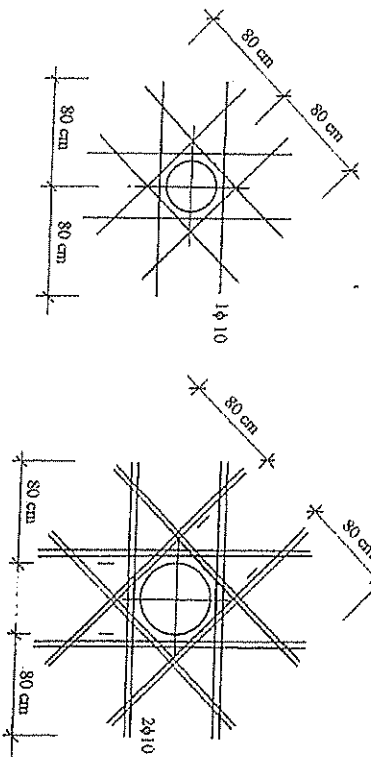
Reforço de abertura em lajes armadas em duas direções
